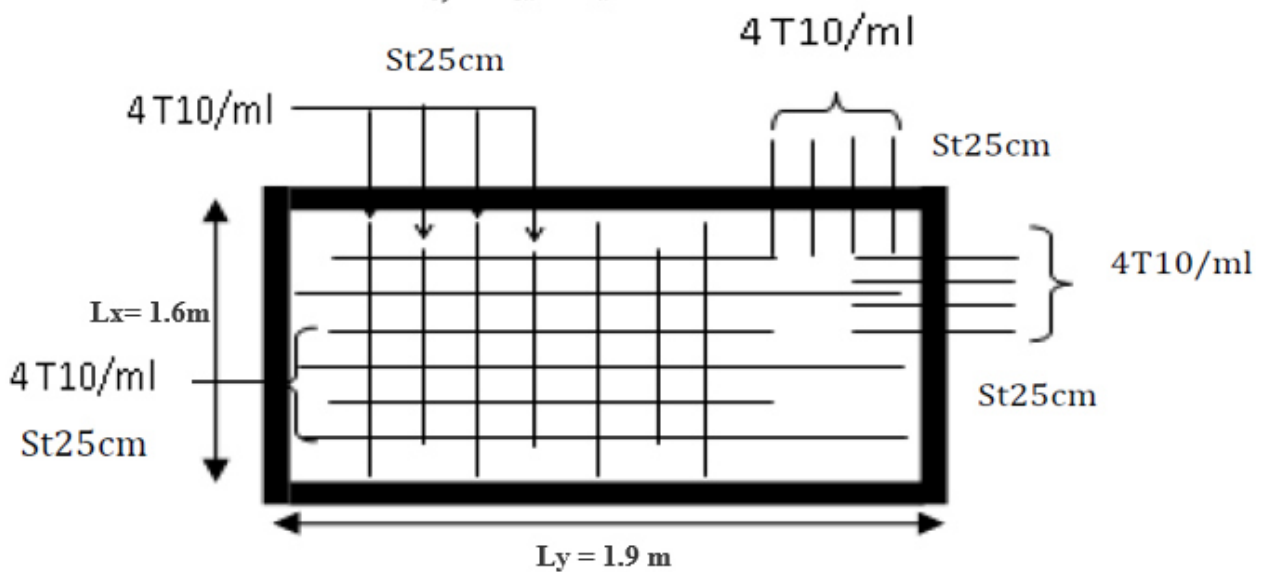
schéma de ferrailage de la dalle d'ascenseur
